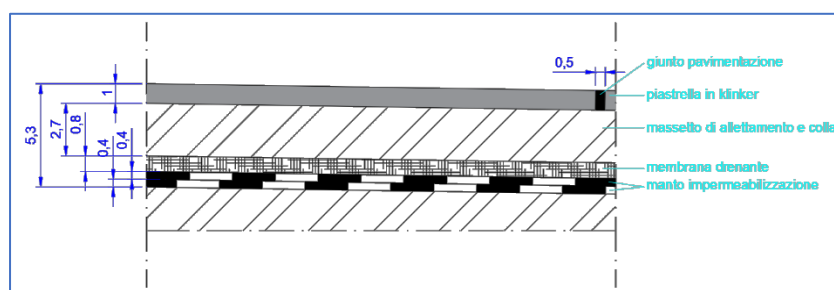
Nuovo pacchetto sopra il massetto esistente.
